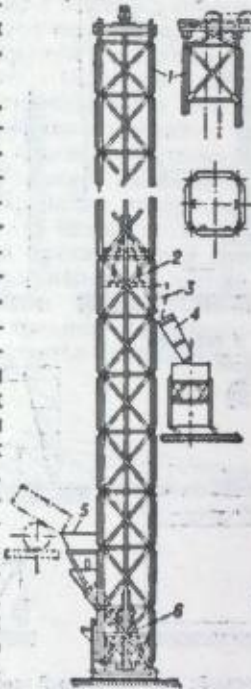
Шахтный подъемник с опрокидывающимся ковшом: 1 — шахта; 2 — клеть в верхнем положении; 3 — опрокидывающийся ковш; 4 — разгрузочный доток; 5 — клеть в нижнем положении; 6 — приемный доток.
